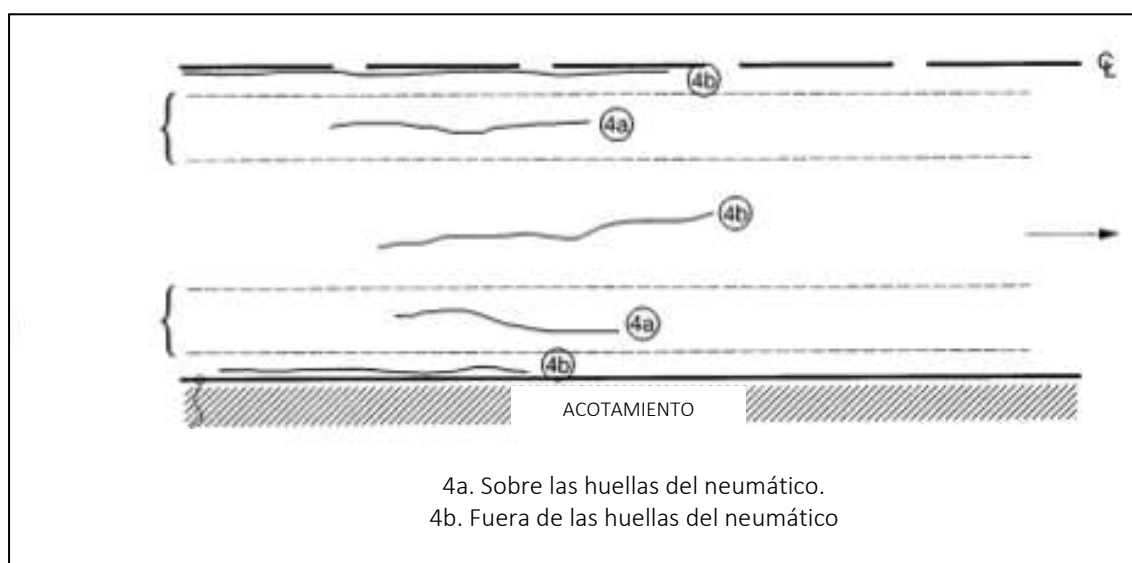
Grietas Longitudinales. (FHWA, 2003)
